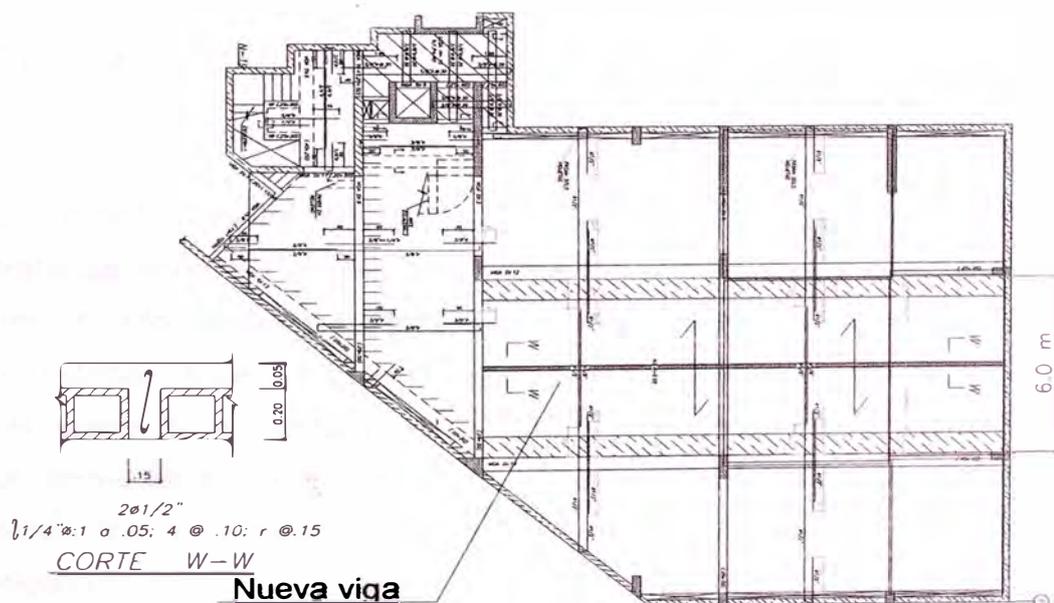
Viga de repartición de carga de 15x25 en losa de sótano. Planta. Ver E-04, Sótano.
